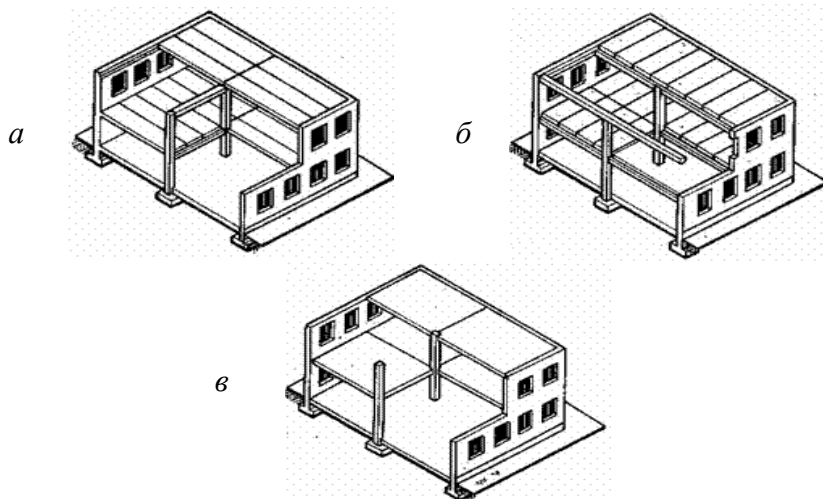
Конструктивные схемы зданий с неполным каркасом:
